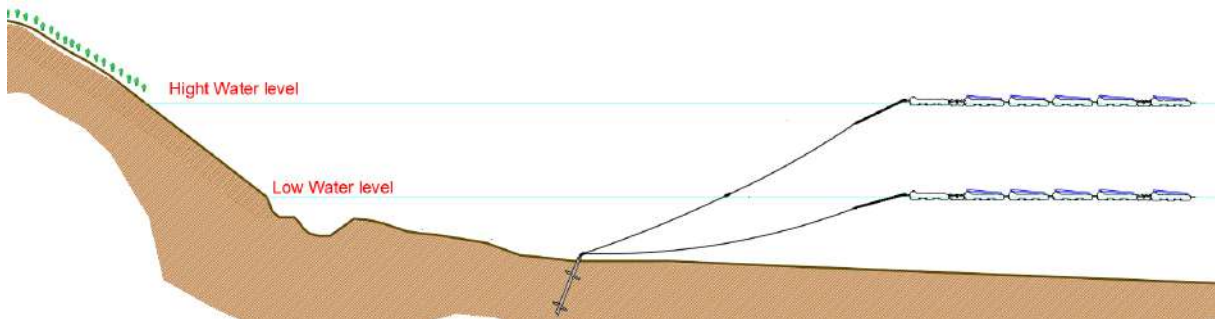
Exemple d'un ancrage au fond à niveau d'eau haut et bas
